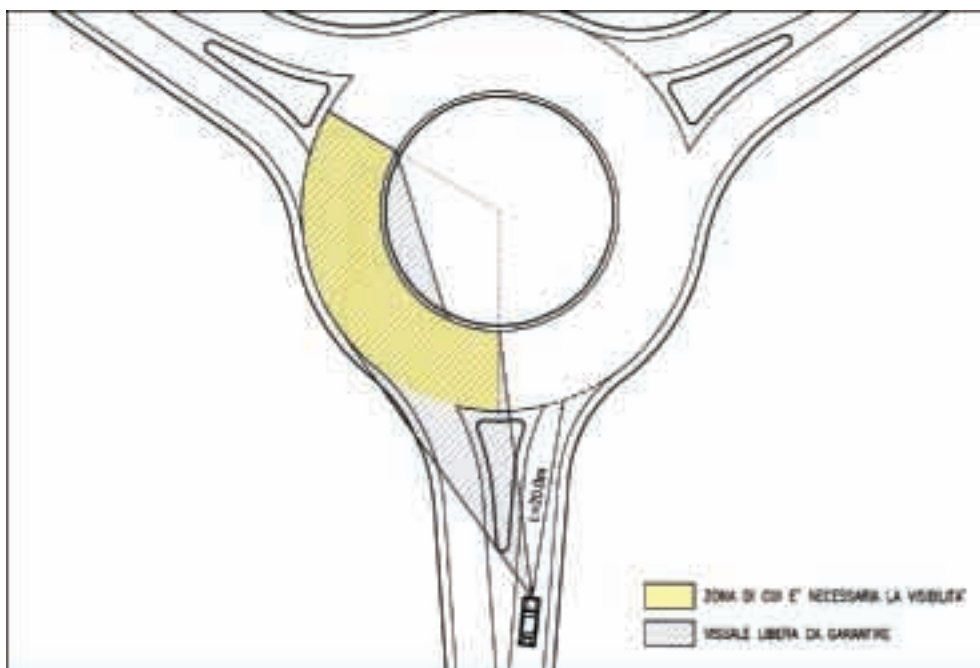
Visibilità dell'intersezione (caso rotonda con 3 bracci)
